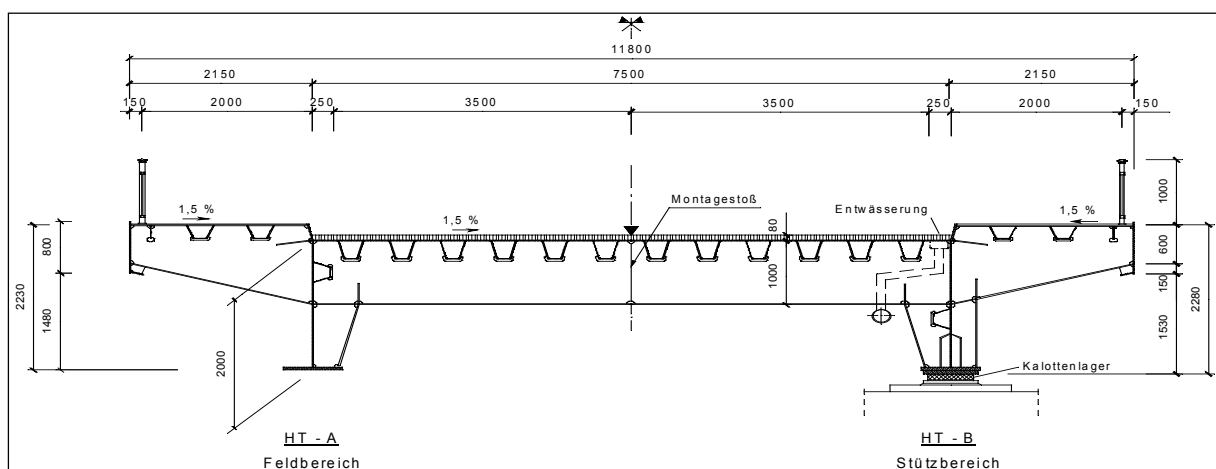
Beispiel Stahlbrücke mit orthotroper Platte
